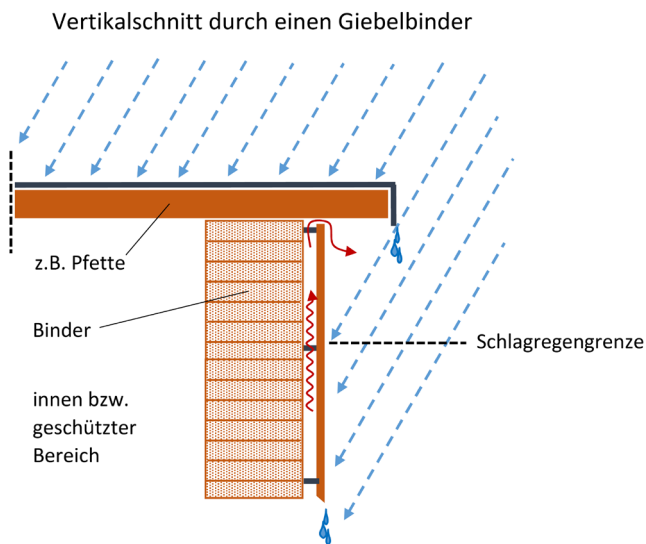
Prinzipieller Aufbau eines einseitigen hinterlüfteten Flankenschutzes
